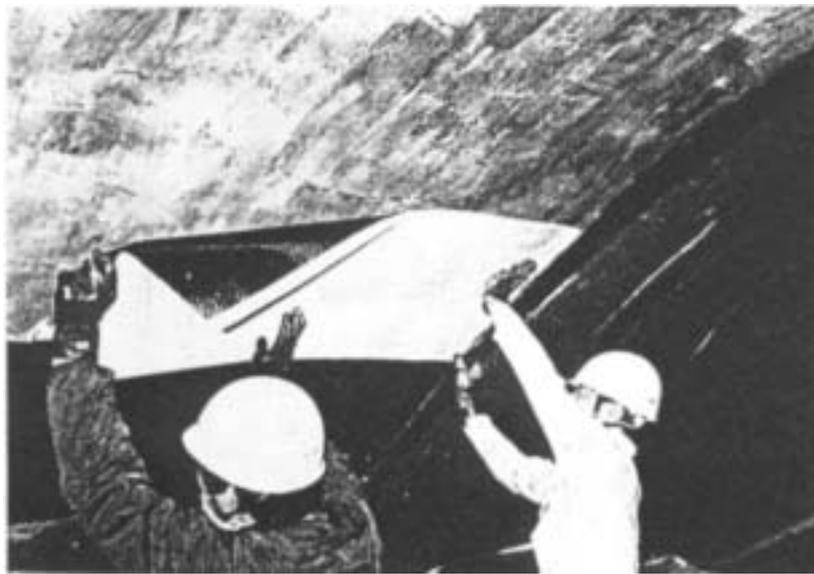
以碳纖維貼布防止隧道內襯砌混凝土塊掉落兼補強之施工案例 [6]
